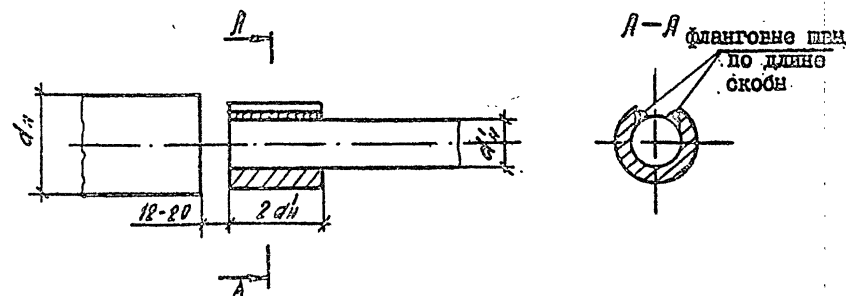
Конструктивные элементы горизонтальных выпусков арматуры, подготовленные к механизированной сварке в инвентарной форме (отношение диаметров свариваемых выпусков - 0,5)
